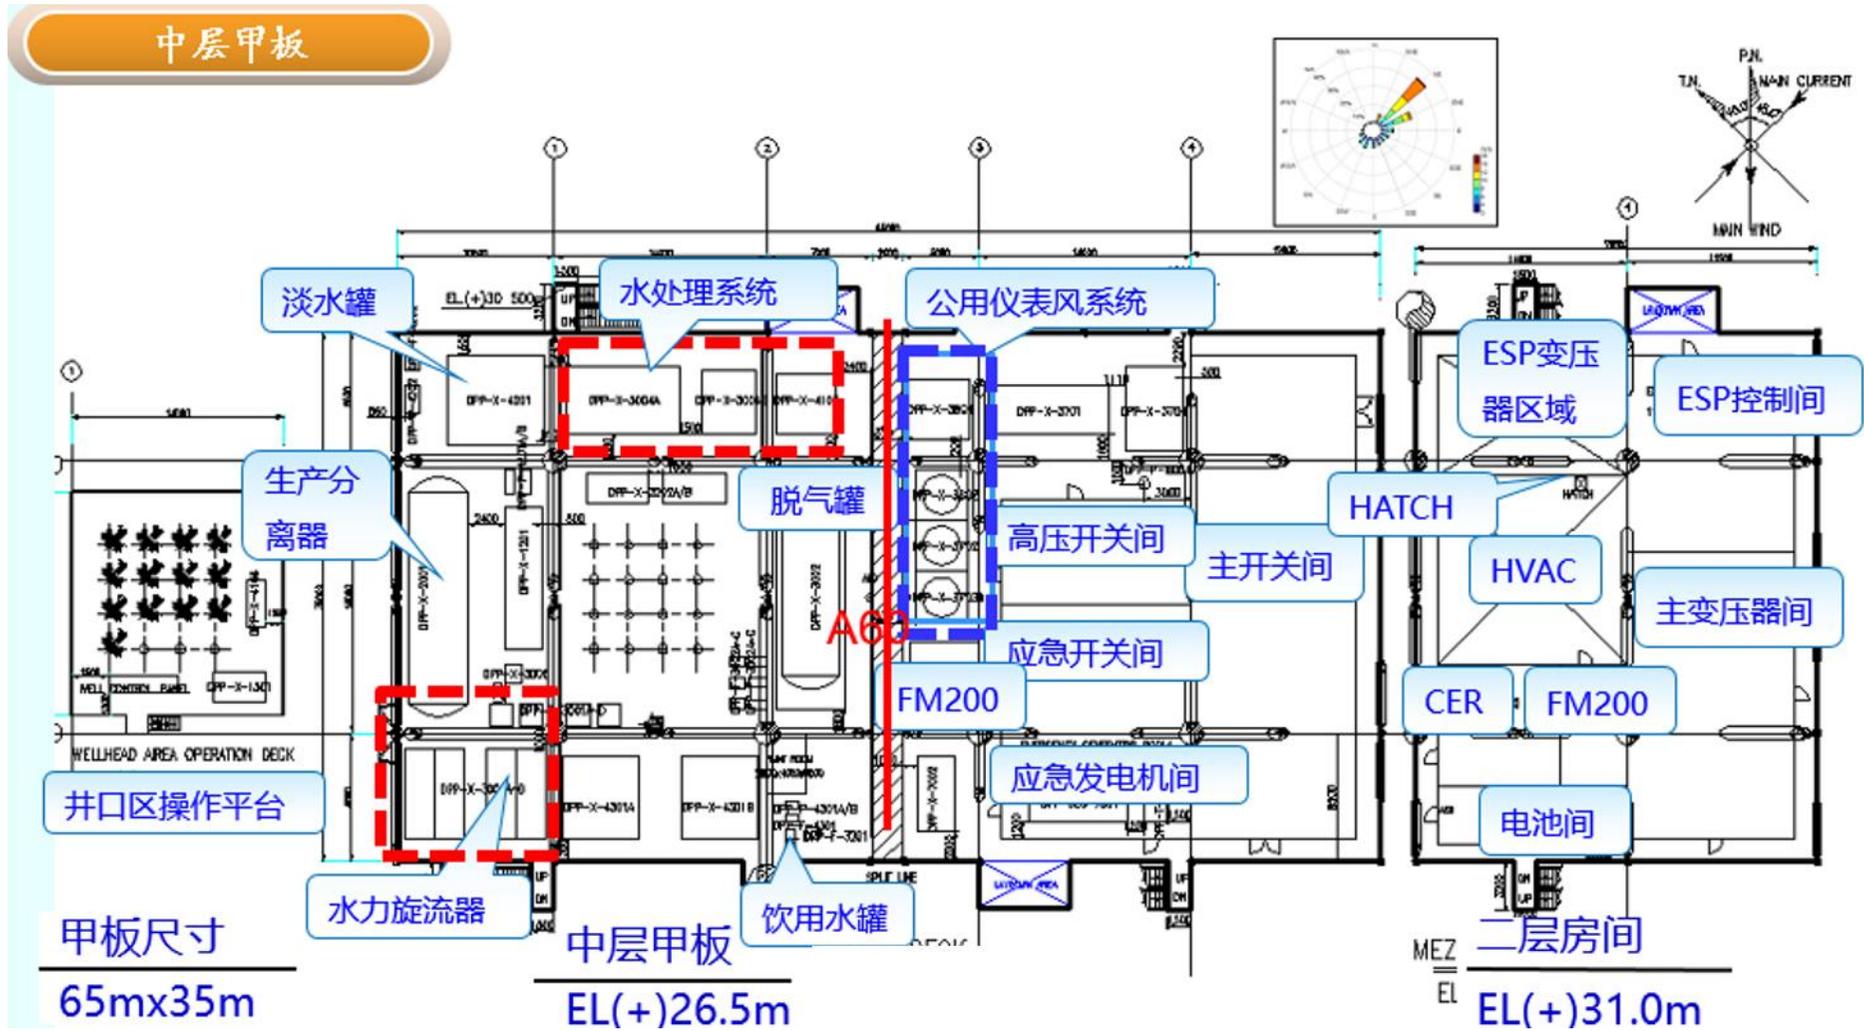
新建 LF15-1 DPP 平台中层甲板平面布置图
